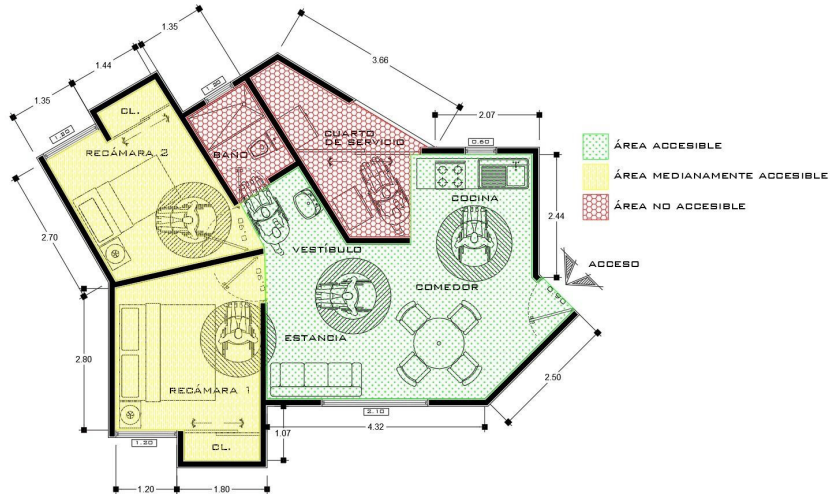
Plano de las áreas de la vivienda (distribución por áreas)
